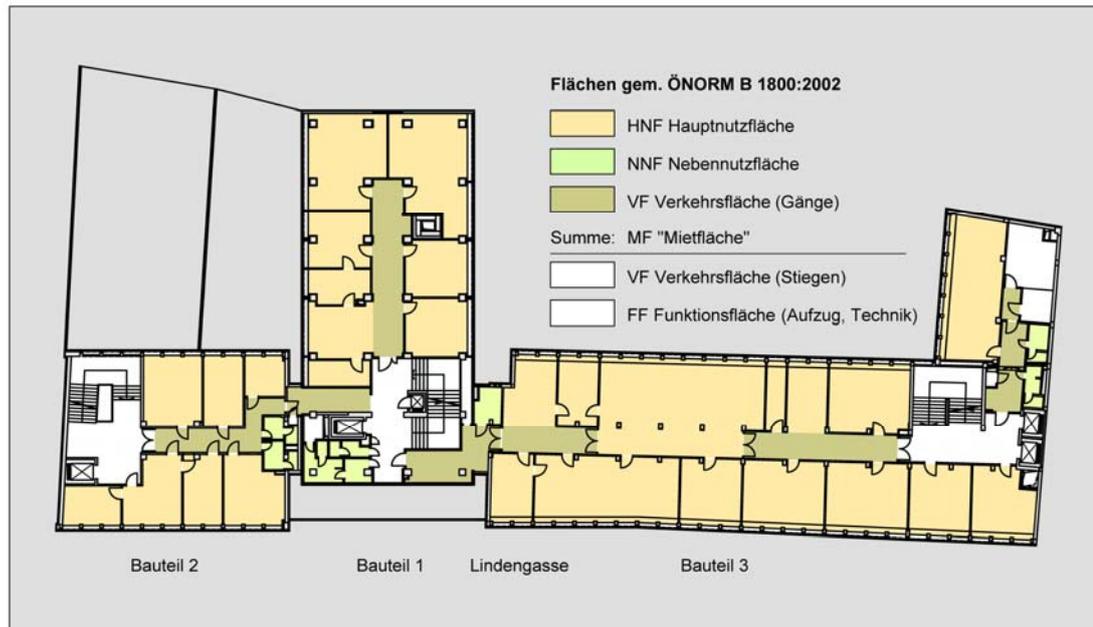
Übersicht Grundriss 3.Obergeschoss, ohne Maßstab<sup>56</sup>
